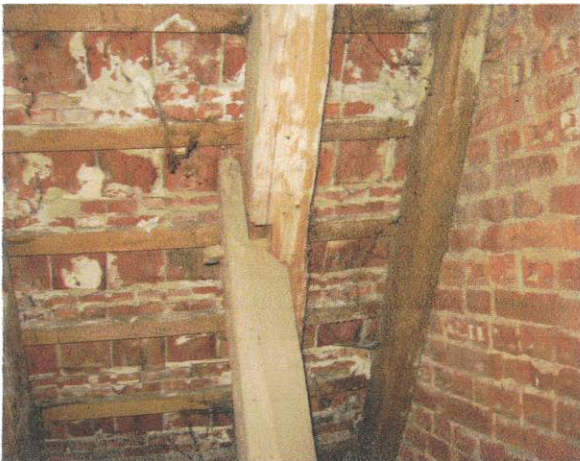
Zarysowanie ściany szczytowej wschodniej ;
